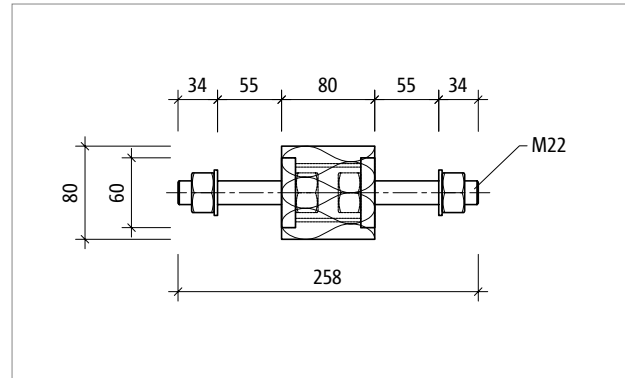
Schöck Isokorb® T type S-V-D22 : coupe du produit
